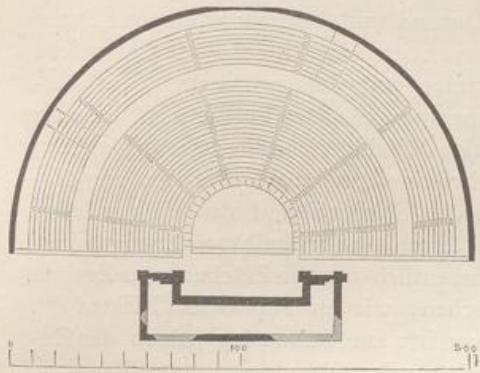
Theater zu Segesta (Grundriss).
